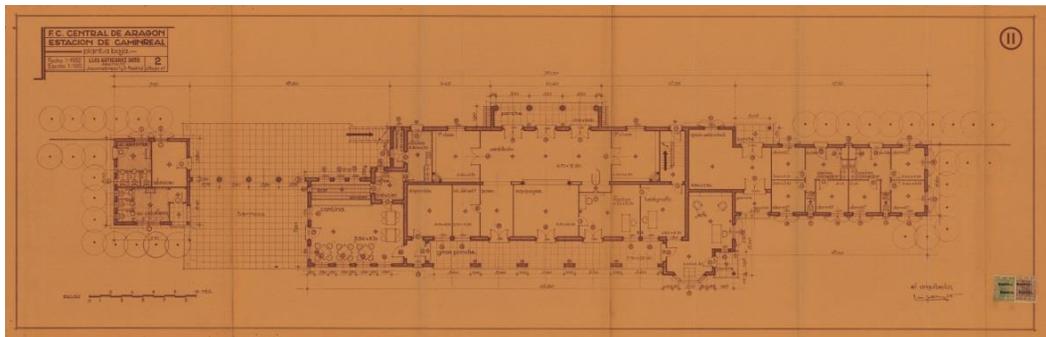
Planta Baja de la estación de Caminreal. Plano de proyecto. (Fuente: Archivo AHF, 1932)
